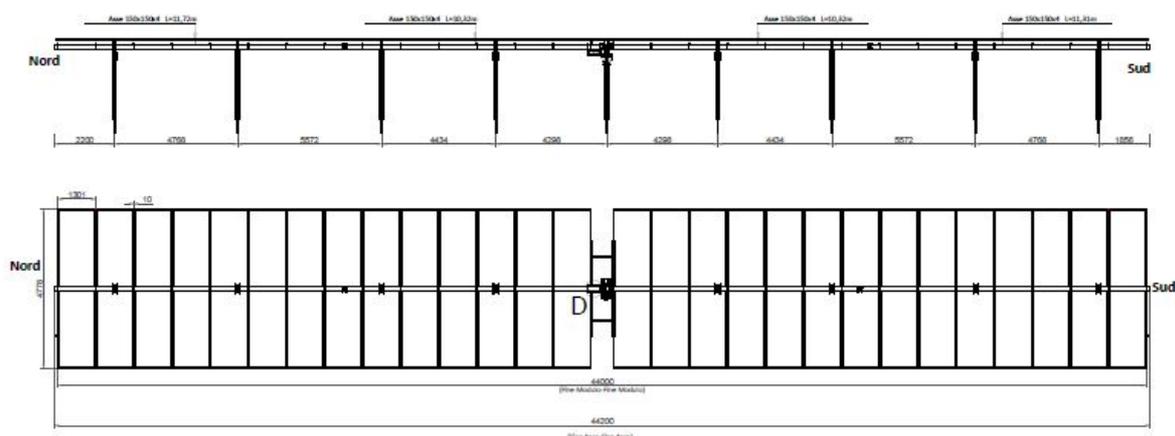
Particolare vista in sezione e in planimetria delle strutture bistringa (28 pannelli)
